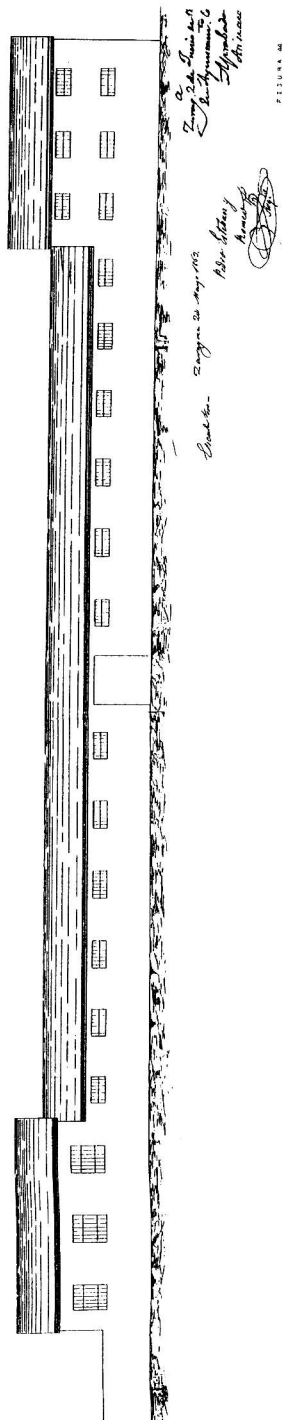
Alzado de la fachada de los nuevos talleres de la S.M.A. proyectados en 1863 por el arquitecto Pedro Esteban y Romeo.
